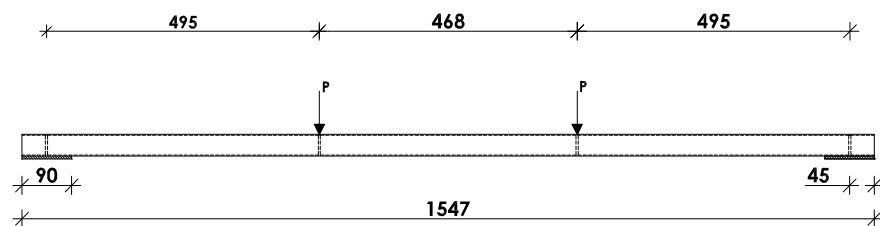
Alçado do ensaio tipo 150×1.5\_Fz1\_Liso (dimensões em mm).
